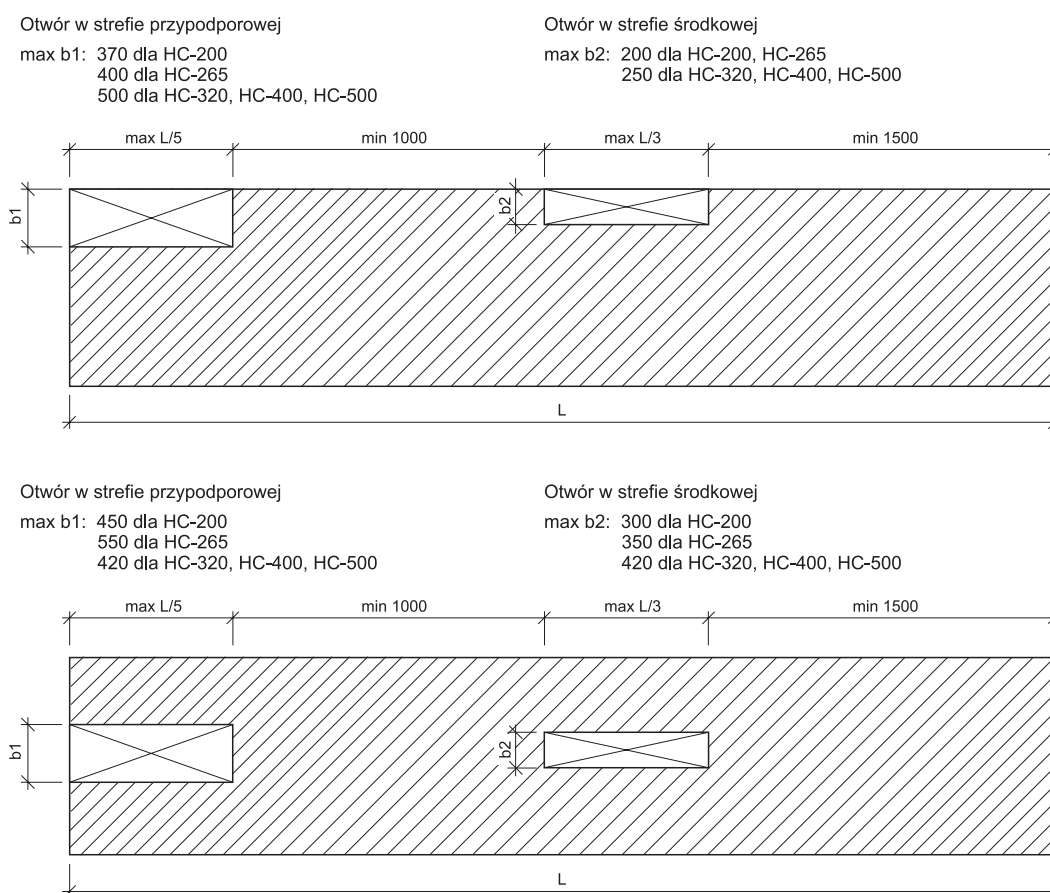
Schemat rozmieszczenia otworów w płytach strunobetonowych HC
